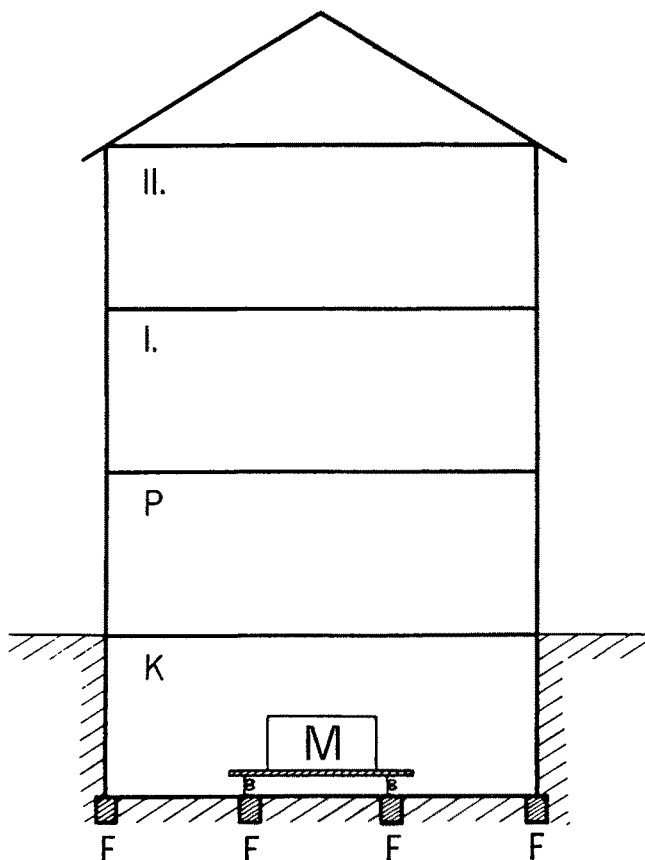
Exemple d'emplacement correct d'une machine vibrant fortement M: Machine, F: Fondations, K: Sous-sol, P: Rez-de-chaussée, I: Premier étage, II: Deuxième étage
